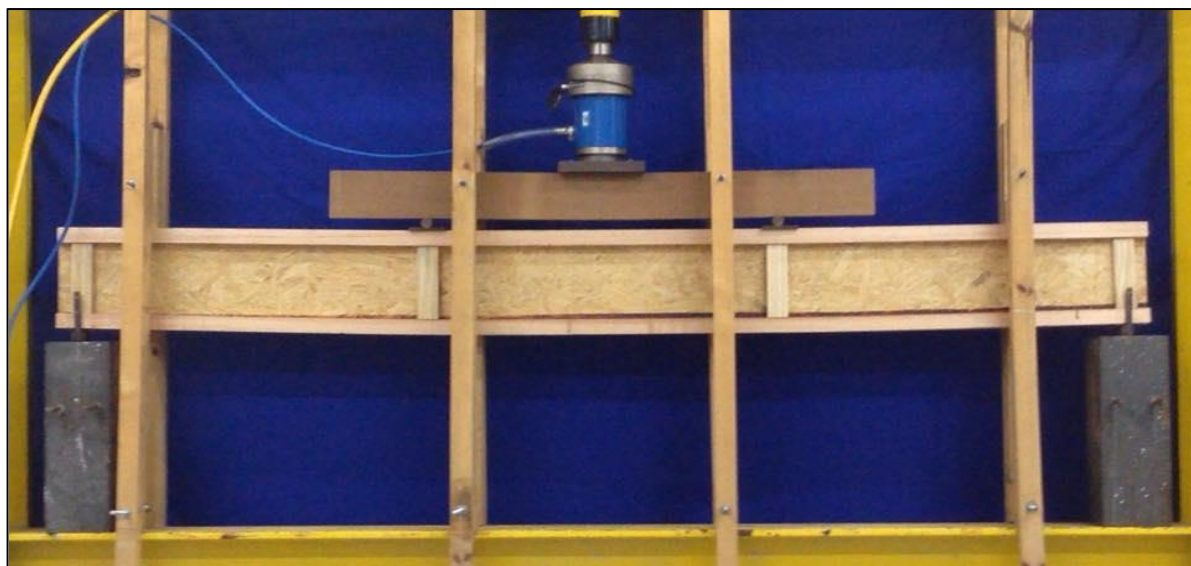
Realização de ensaio de flexão em viga I-Joist
